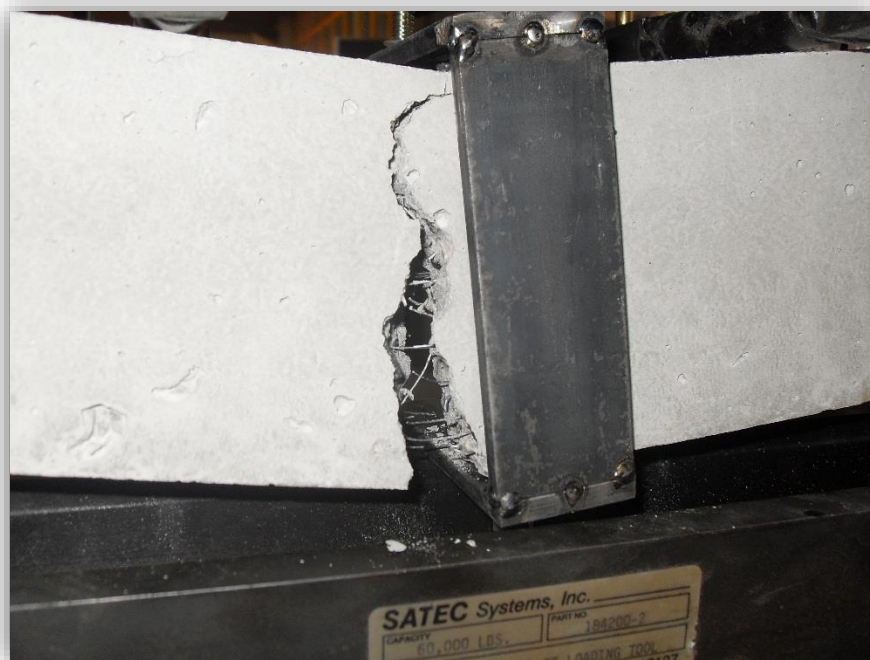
Falla del elemento después de la aplicación de la carga máxima de la viga VFA4
